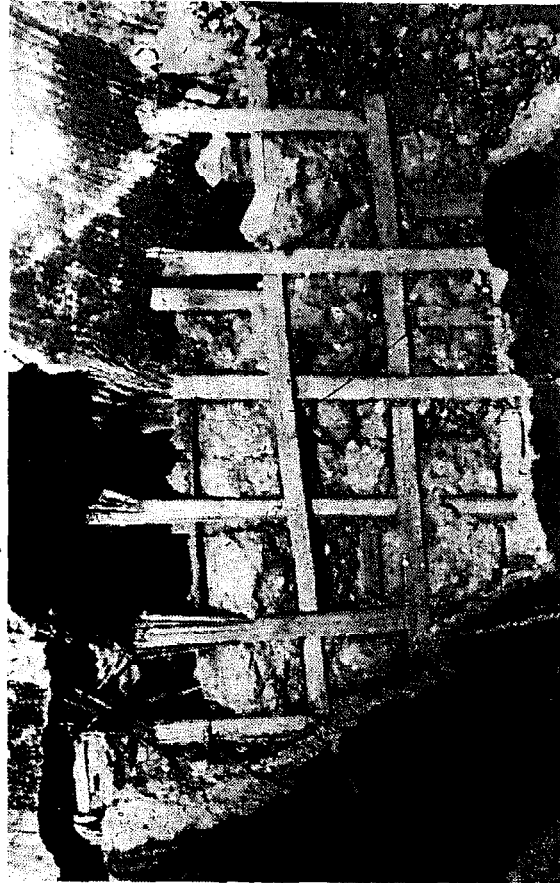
Detalle en el cual se nota la falta de adherencia entre el bambú y el concreto.
